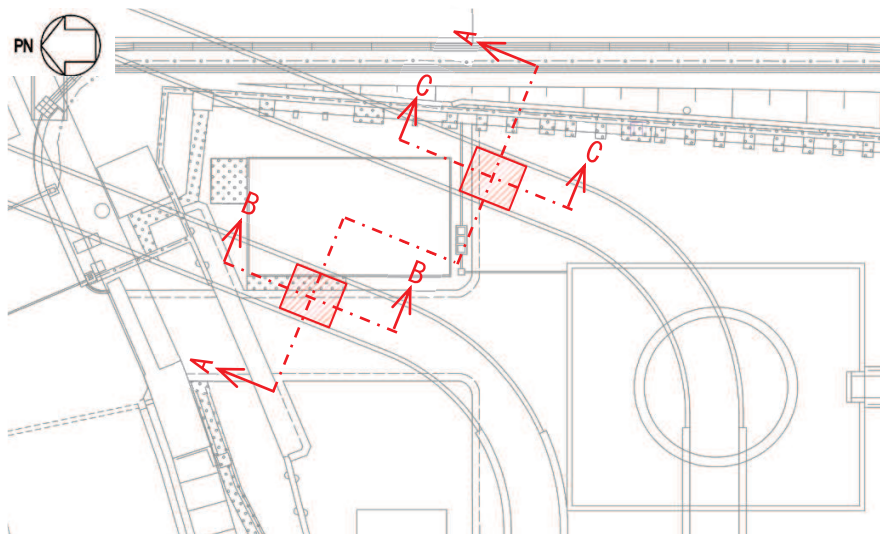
取放水路流路縮小工（第1号機取水路）（No.1），（No.2）の平面配置図
